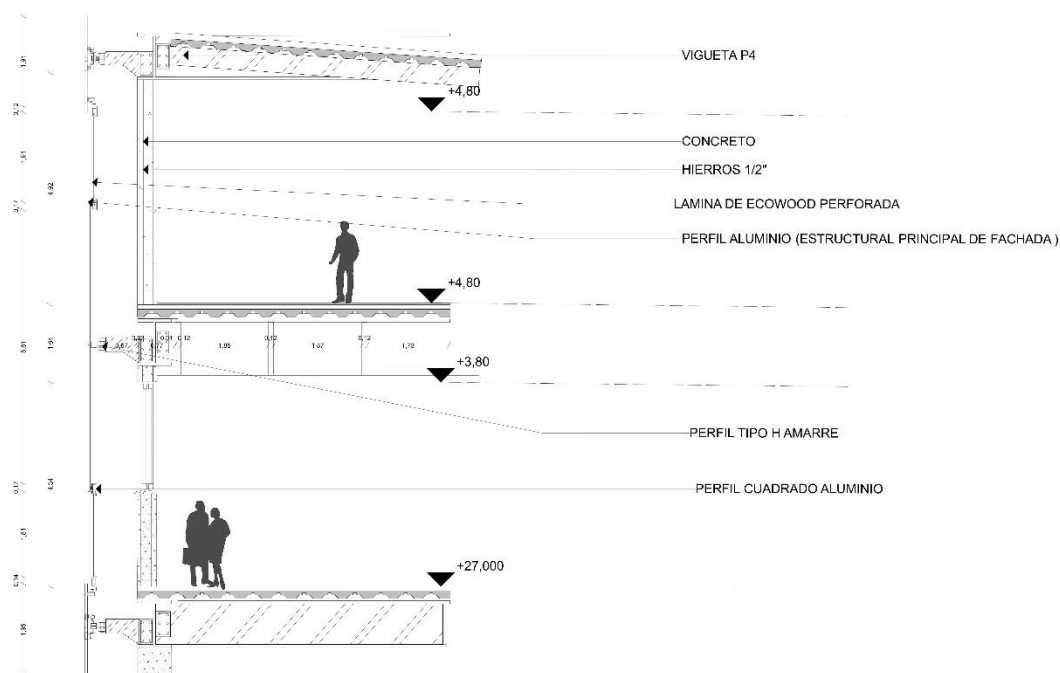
Corte alzado longitudinal con orientación sur-norte
